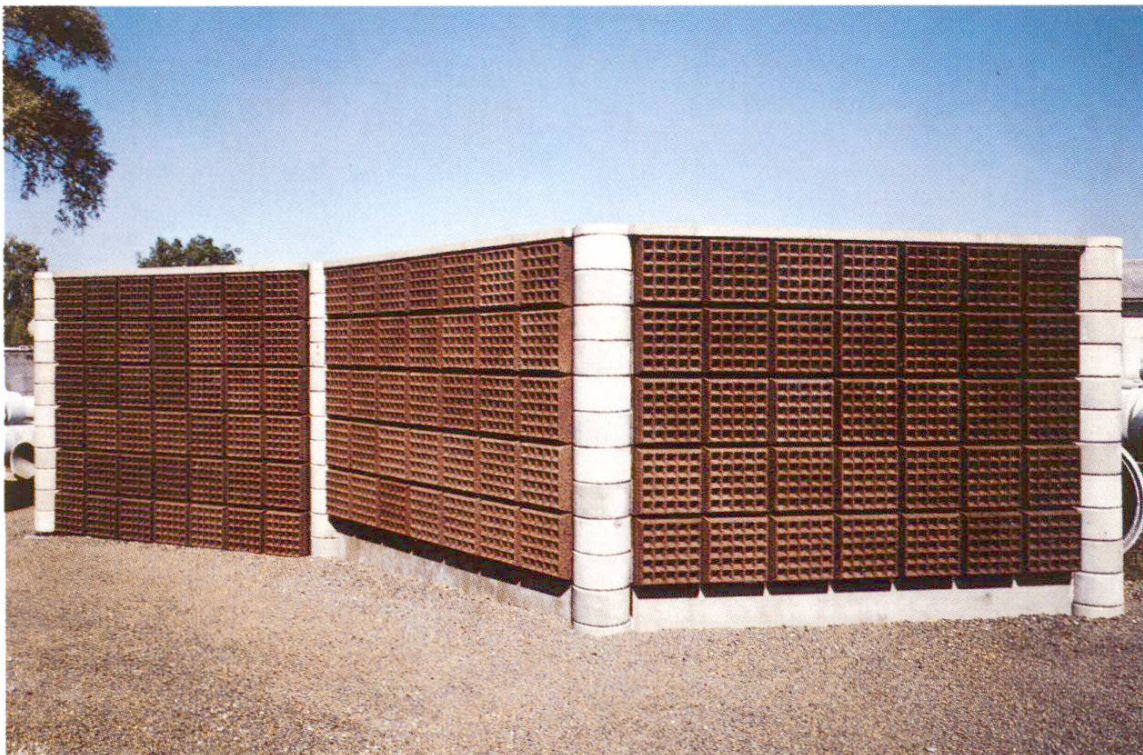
Favorit-F. Faltwand für flexible Linienführung im Grundriss. Tragend sind Stahlrohrstützen auf Einzelfundamenten im Abstand von 3,93 m. Der Wandaufbau erfolgt mit horizontalen Lärmschutzelementen ($h=50$ cm), die an ihren Stirnseiten mit Betonringen von halber Elementhöhe versehen sind.
